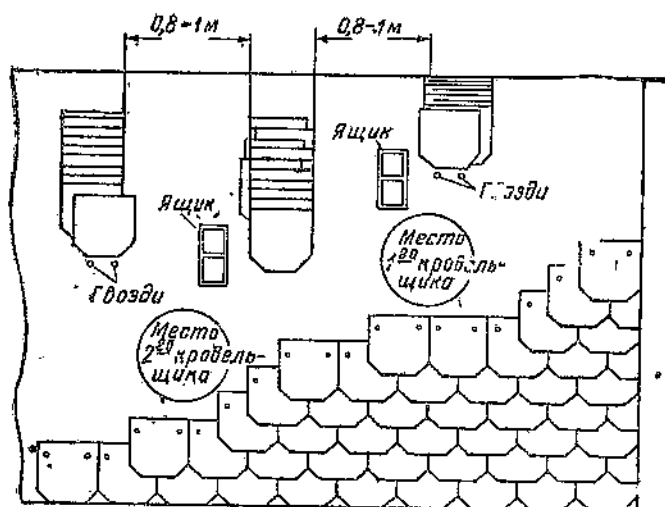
Организация рабочего места на крыше при покрытии плитками.
